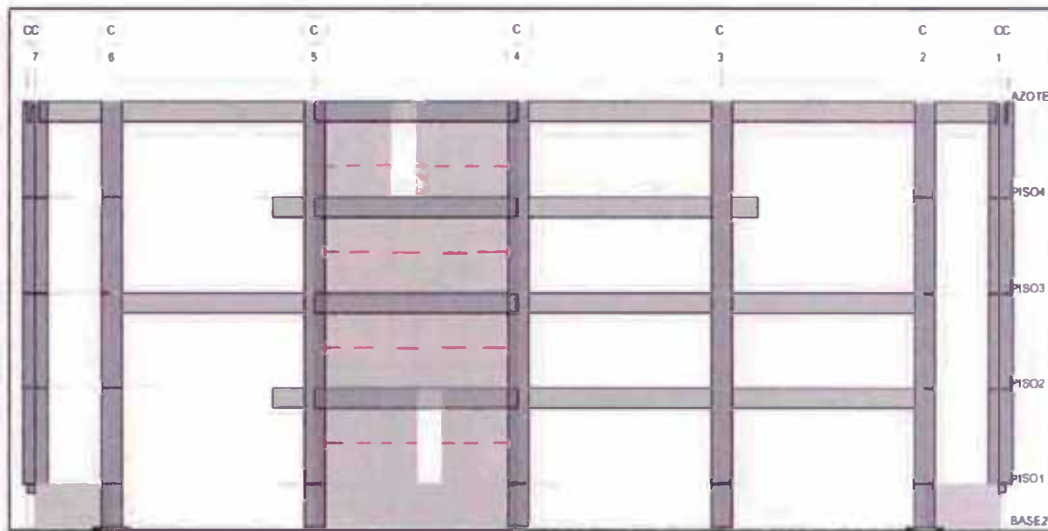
Fisuras visibles (líneas discontinuas).
